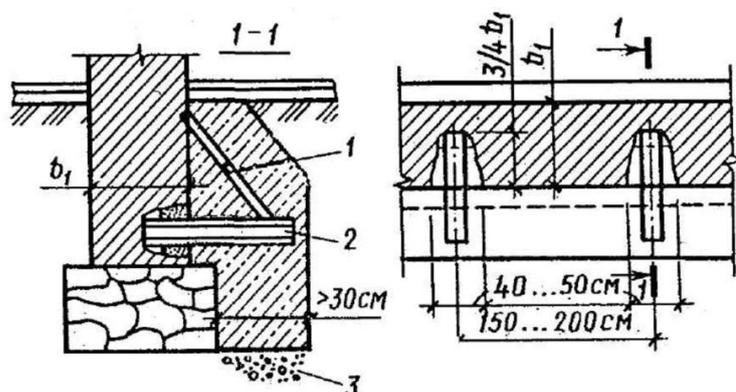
Одностороннее расширение ленточного фундамента: 1 – подкос; 2 – разгружающие балки; 3 – щебеночная подготовка.
